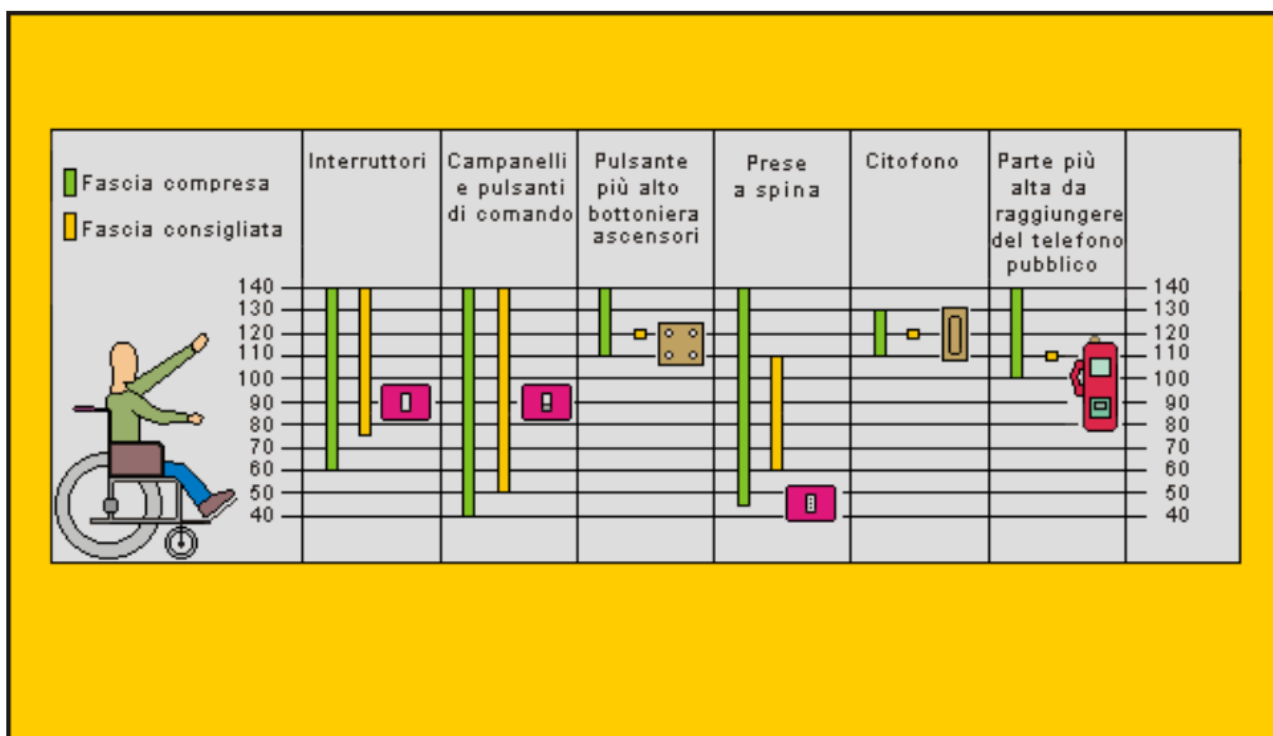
Ubicazione delle apparecchiature elettriche ai fini dell'abbattimento delle barriere architettoniche
